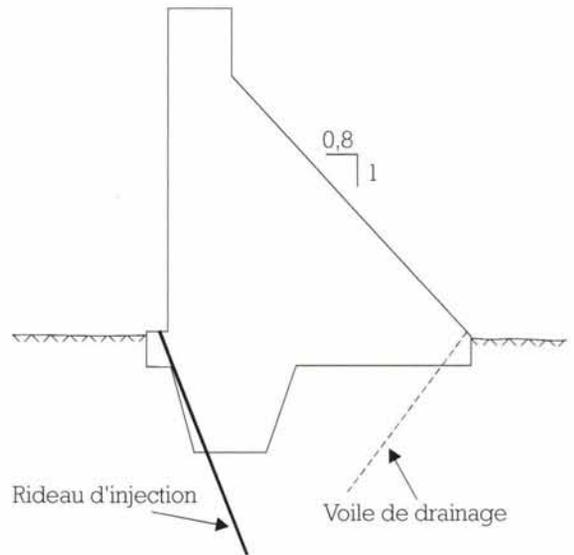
Profil type d'un petit barrage-poids en béton (d'après [40]).
